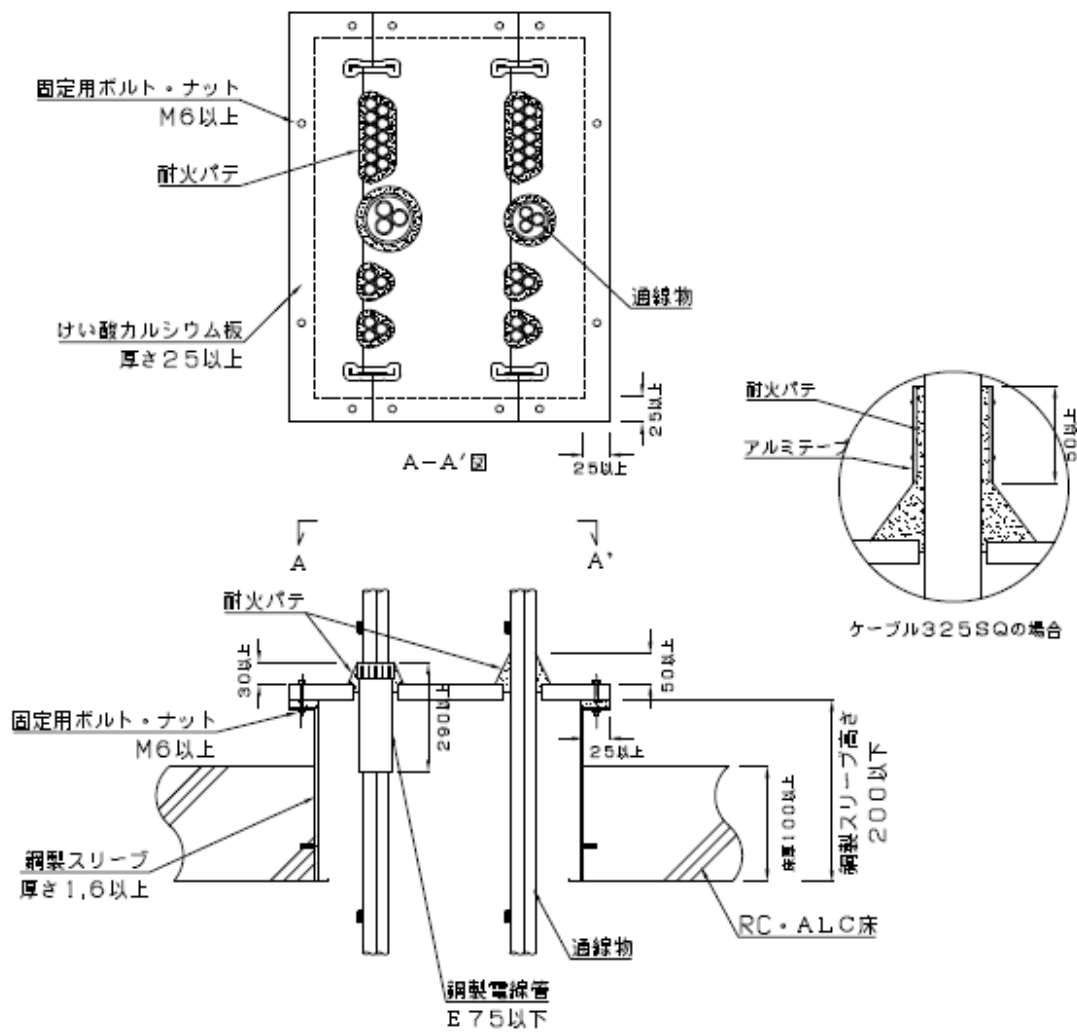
鉄筋コンクリート床(鋼製スリーブあり)貫通部の標準施工図
